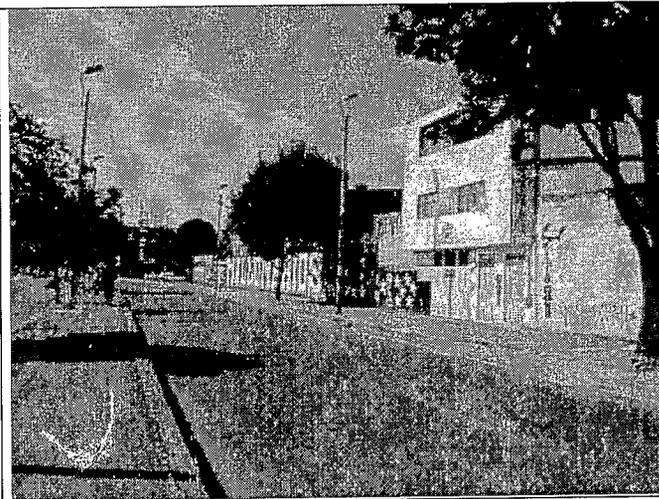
Vista de la vía de acceso en sentido Nor – Este, Dg 71Bis
